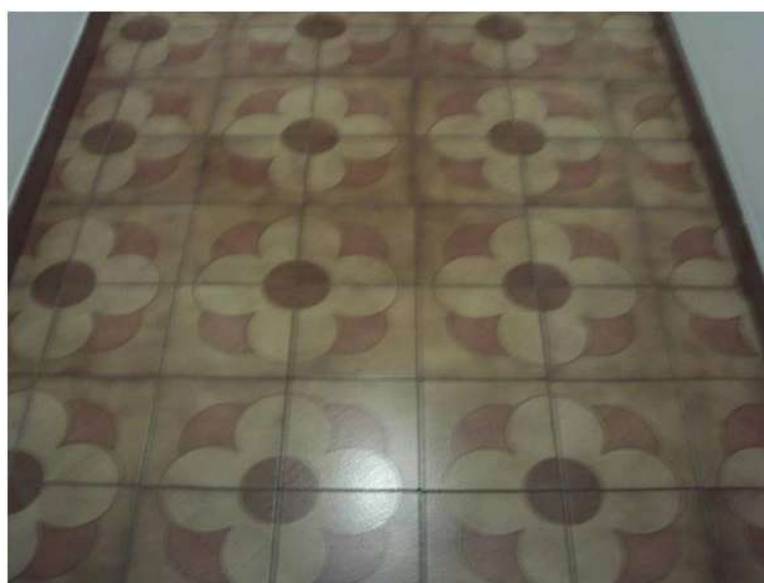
Foto interno : corridoio – sub 3 piano 1°
